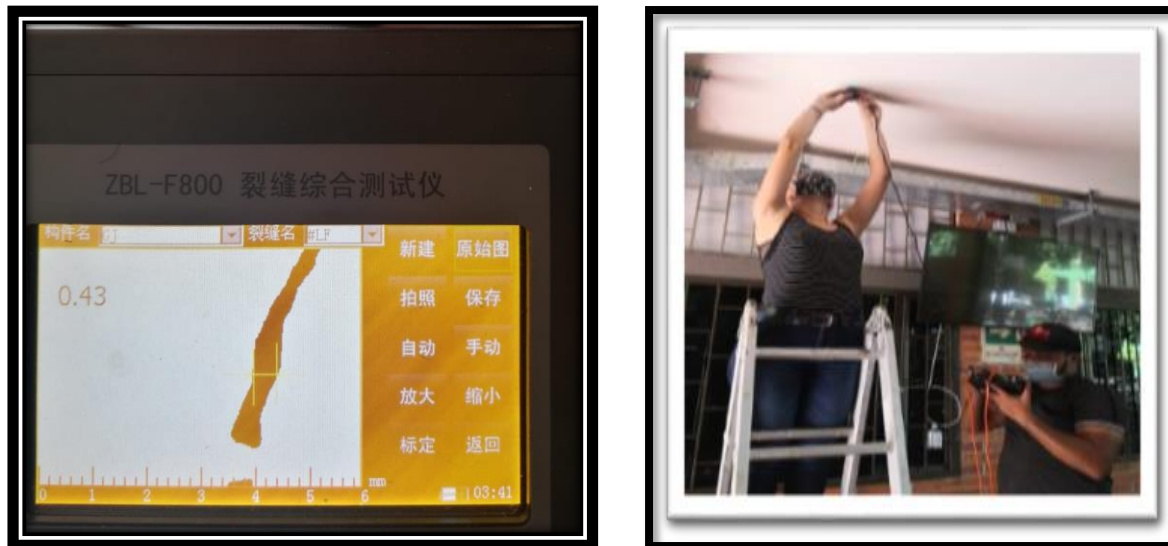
medida de ancho de fisura ZBL F-800
